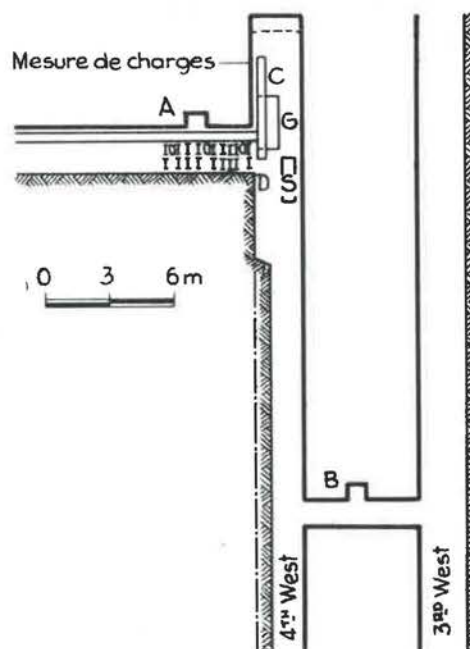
Plan à plus grande échelle donnant la situation des niches d'essais
